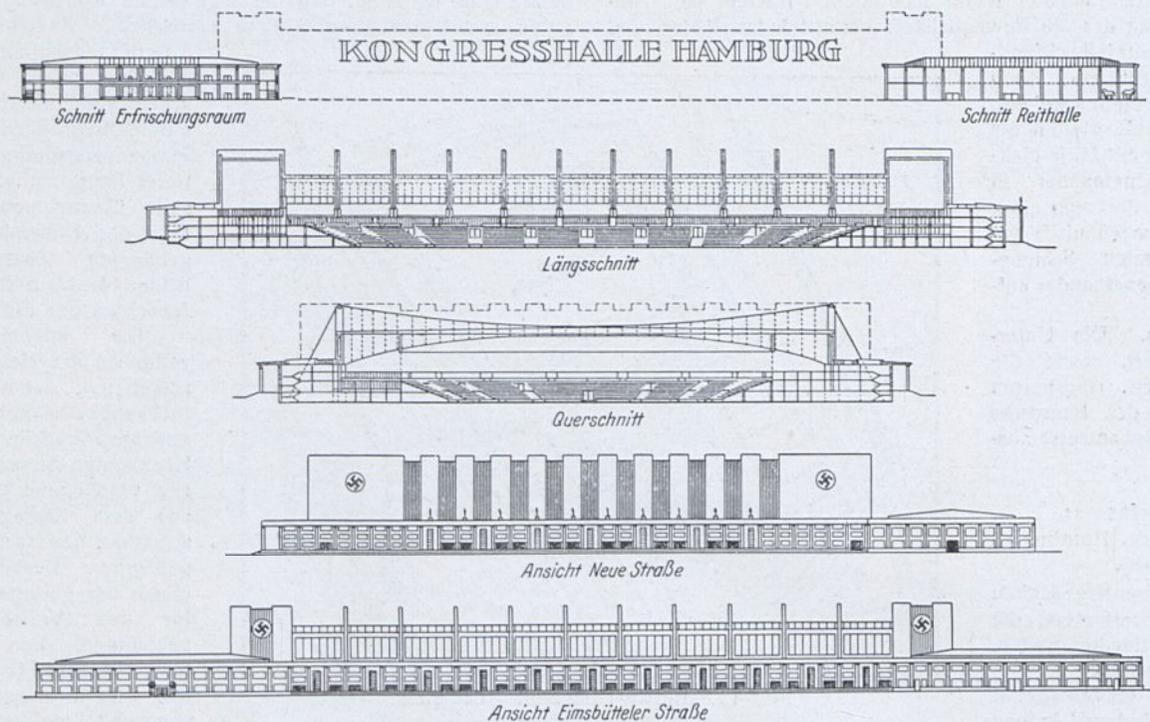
bis e. Entwurf Schmidt. Ansichten und Schnitte.
